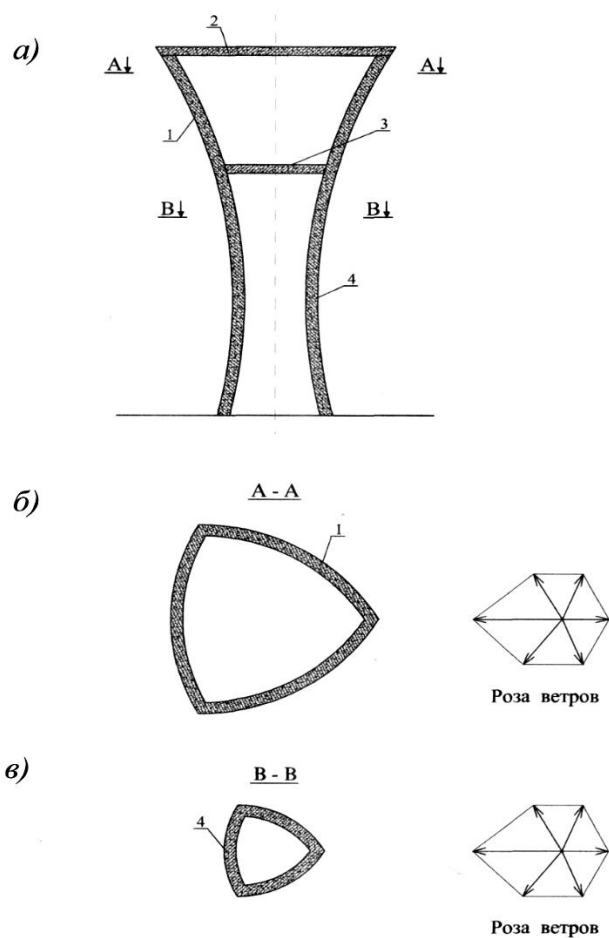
Водонапорная гиперболическая башня, выполненная в поперечном сечении в форме треугольника Рело: а) продольный разрез; б) поперечный разрез А-А резервуара; в) поперечный разрез В-В опоры.
